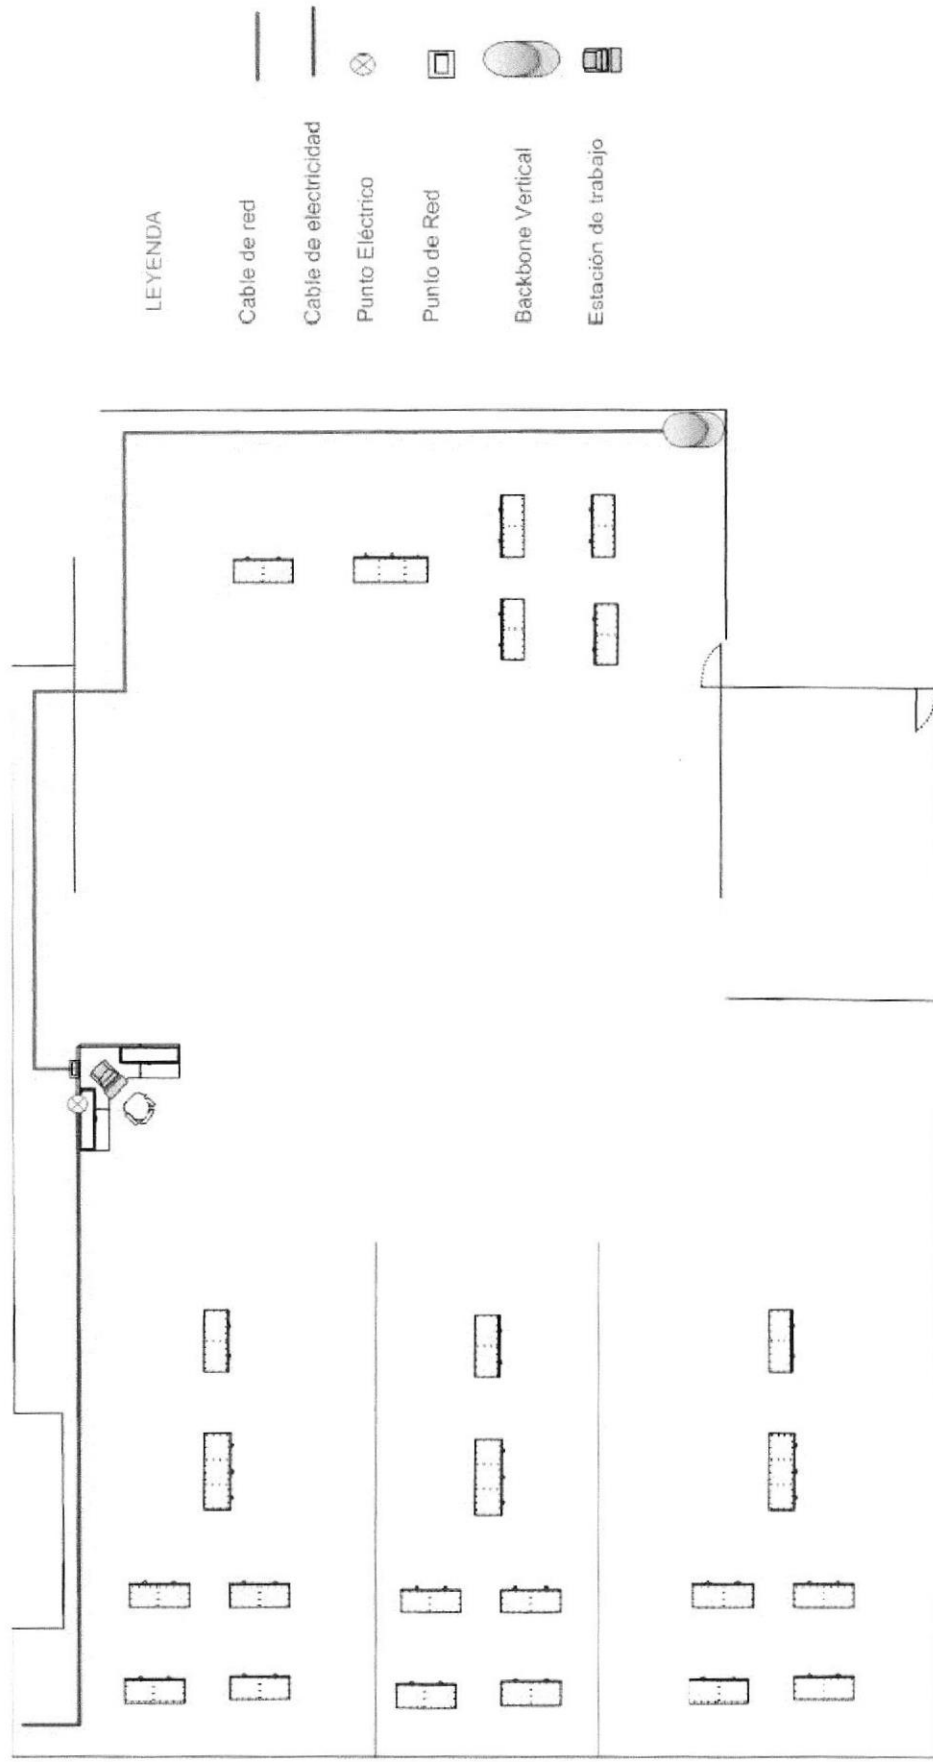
MEZANINE EDIFICIO SUCURSAL SUR
